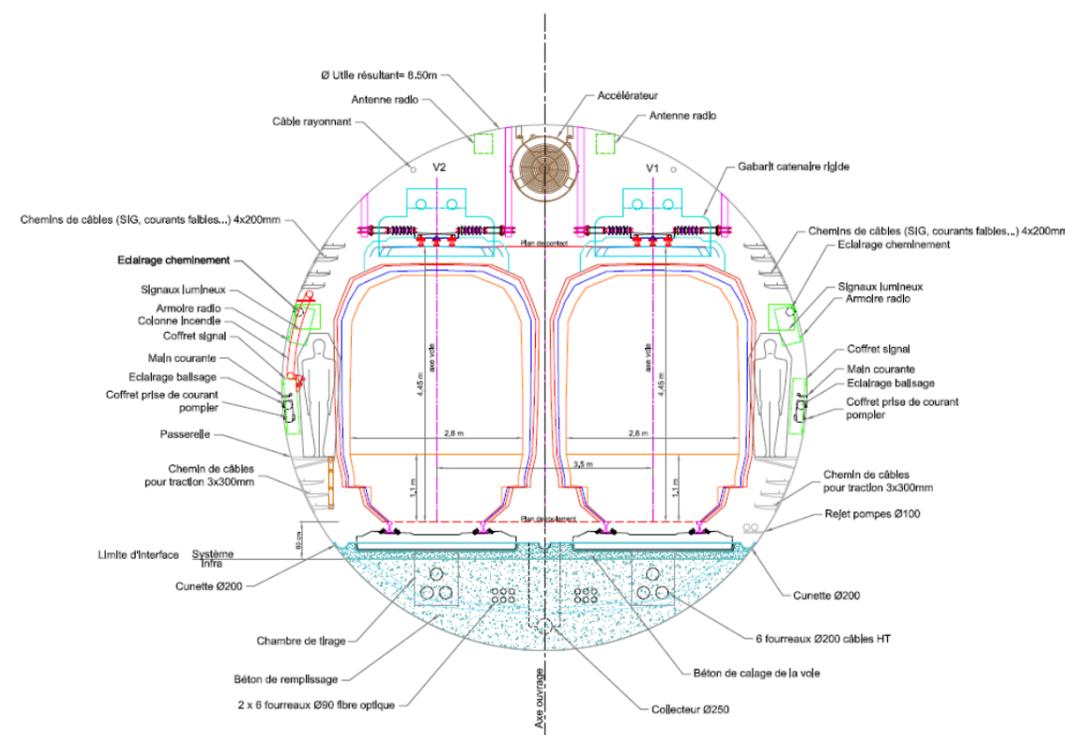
Coupe Tunnel bi-voies Ø 8,5 m – Section courante en alignement droit
